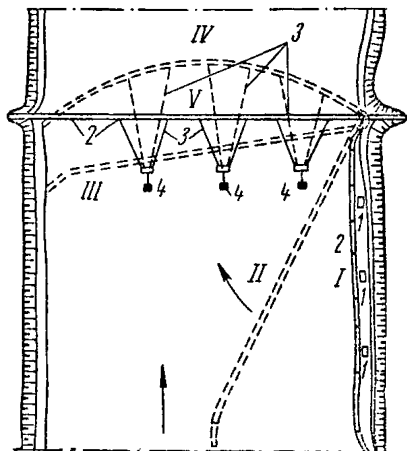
Схема установки трубопровода в створе разворота на плаву
